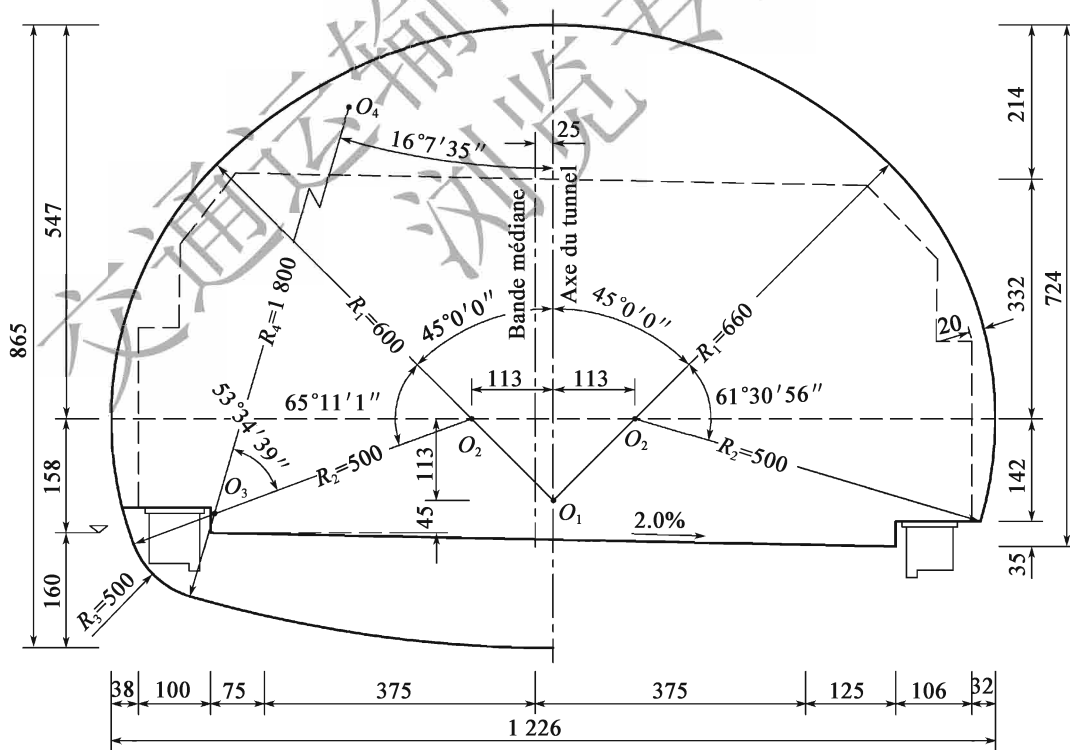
Gabarit du tunnel autoroutier à deux voies(120km/h) (unité:cm)
